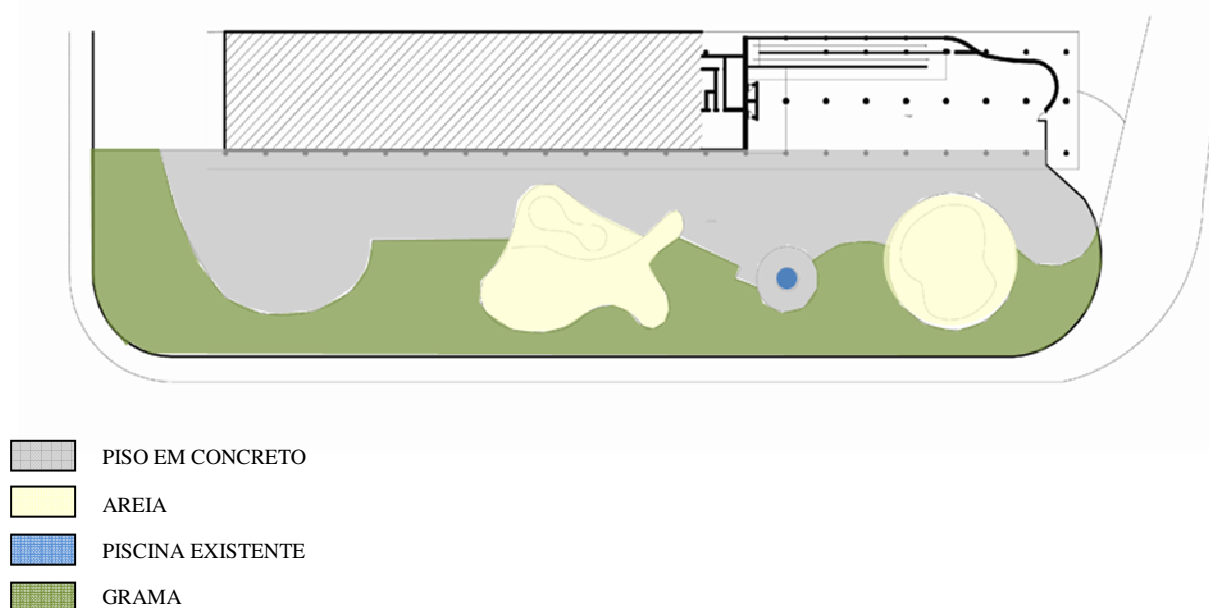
planta baixa do primeiro pavimento do Bloco D do IPPMG, indicando as diferentes texturas de pavimentação existentes no pátio descoberto. Sem escala.
